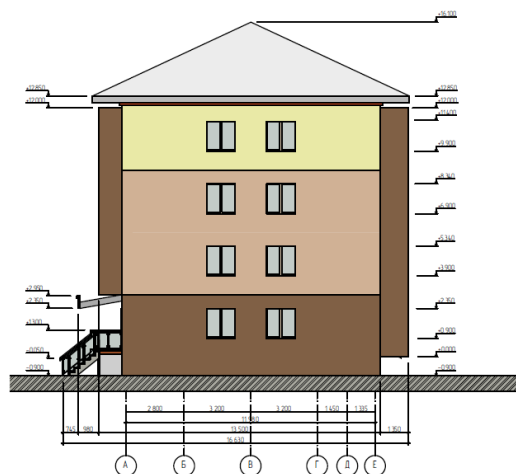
Фасад типового кирпичного пятиэтажного дома. Вид сбоку, вариант 1
